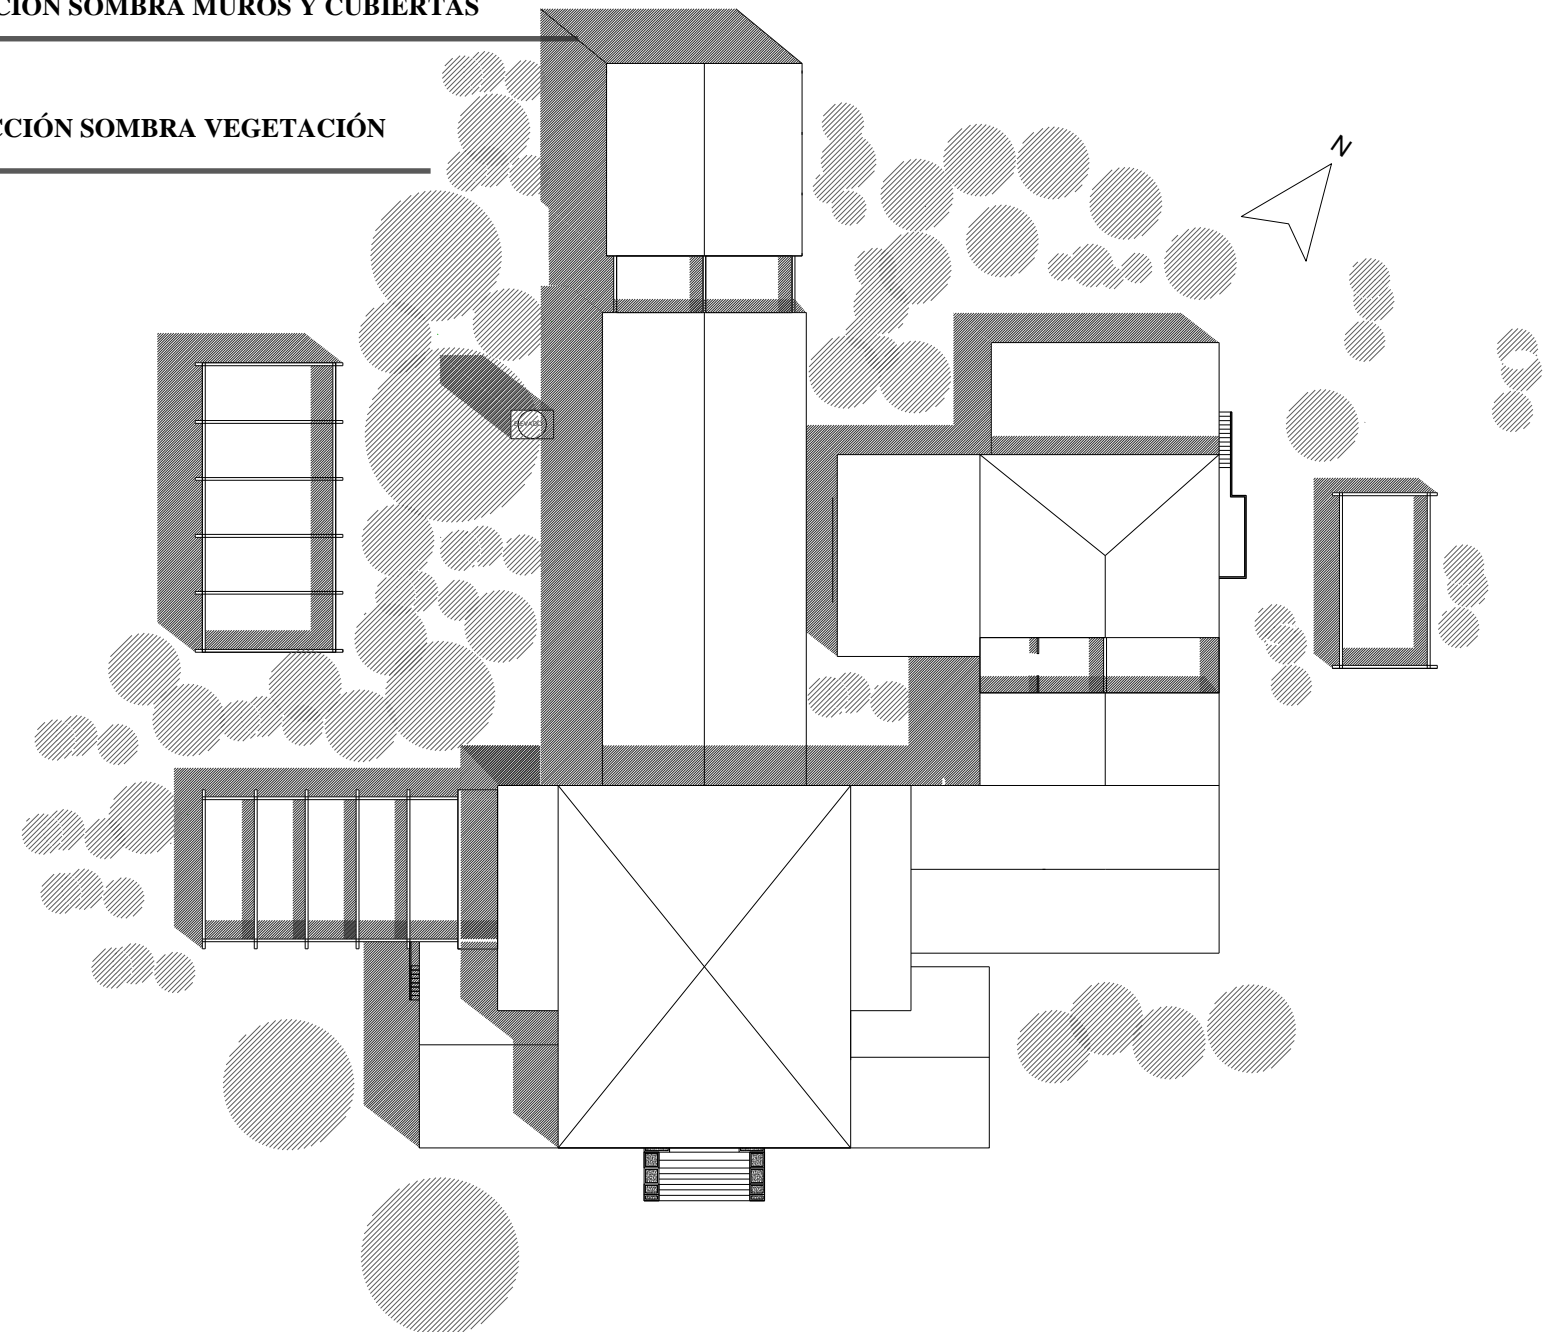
Plano de soleamiento. Sombras Proyectadas en la edificación actual (Muros, Cubiertas y vegetación)
